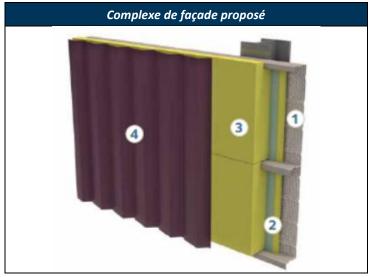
Complexe de façade proposé pour la création d'un bâtiment technique ELOGEN
